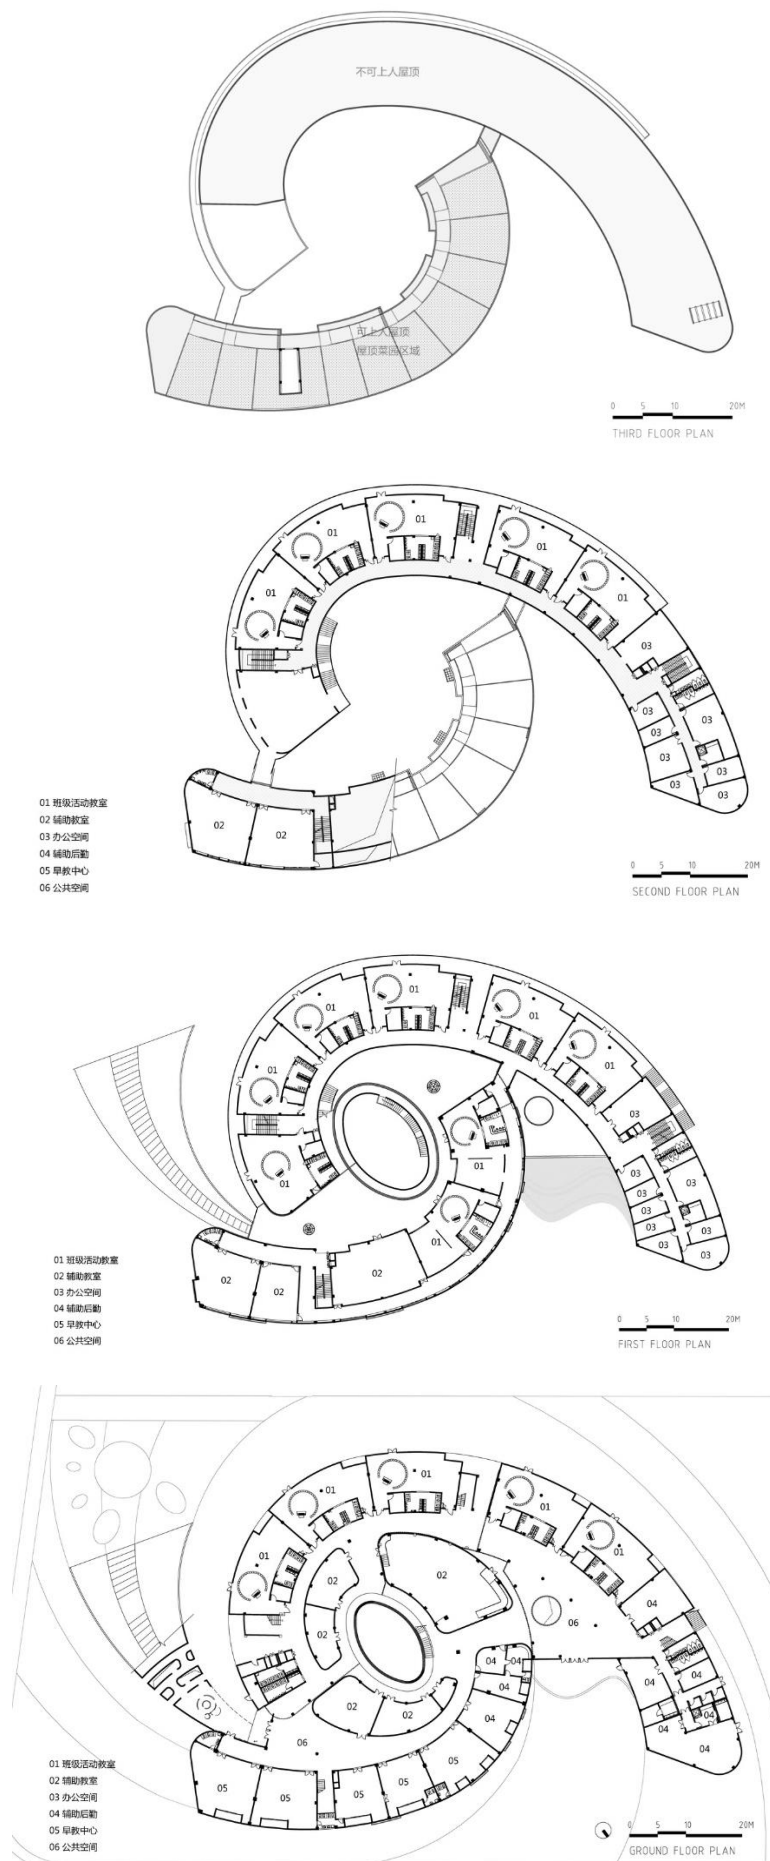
Планування дитячий садок Sanmen Dafu [5]
